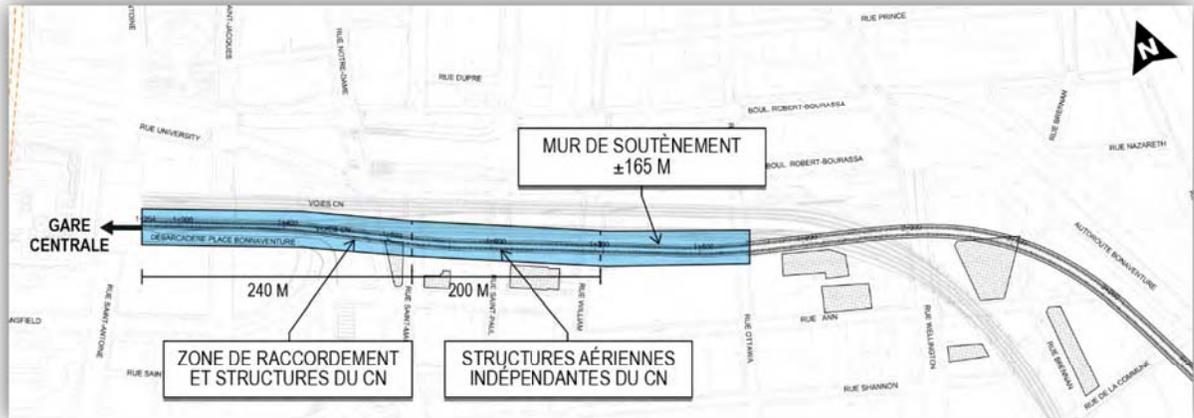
Vue en plan des voies élevées au centre-ville
